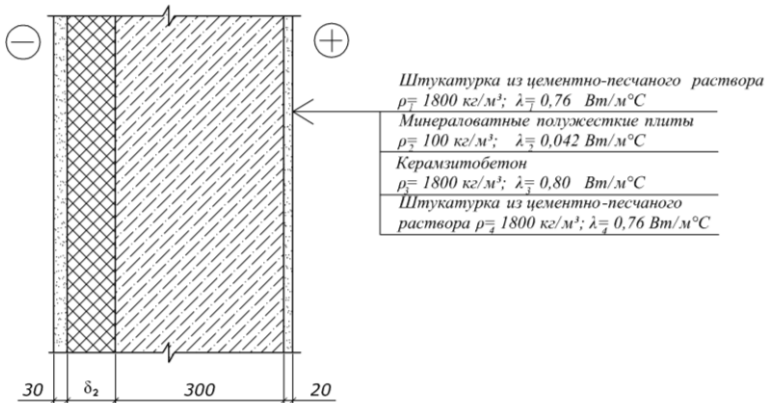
Схема к расчету утепленной снаружи однослойной стеновой панели
